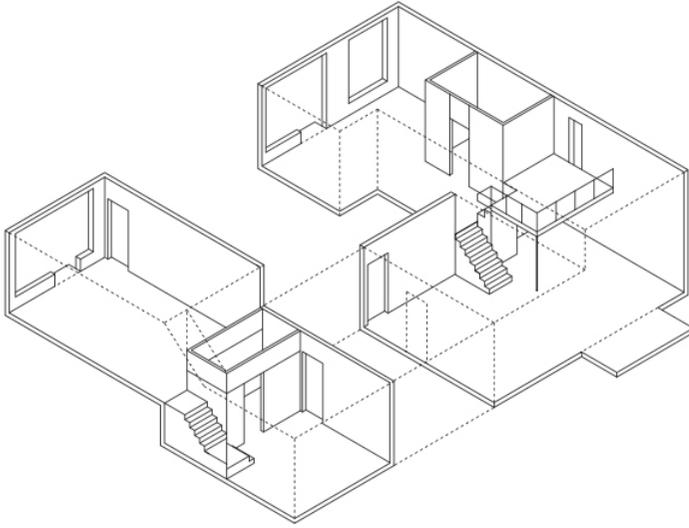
Mischen Possible, Grundriss 3.OG
